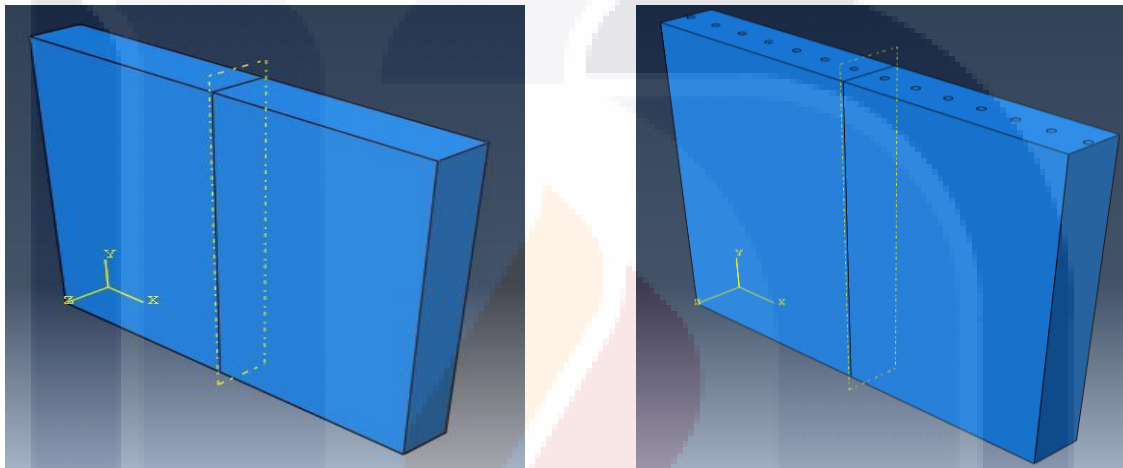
Muro de concreto sin refuerzo y con refuerzo.
